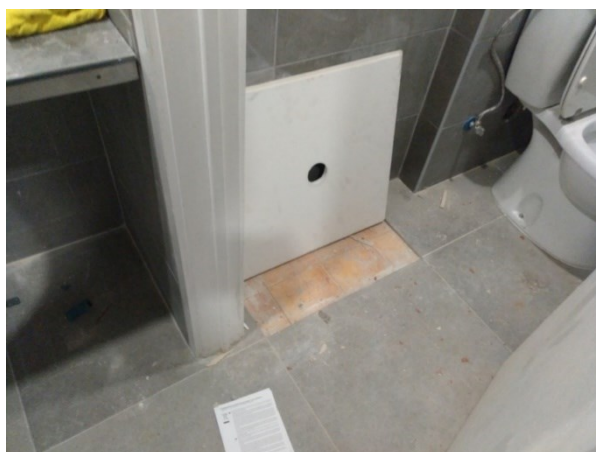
Colagem sobre os pavimentos existentes, I.S.
